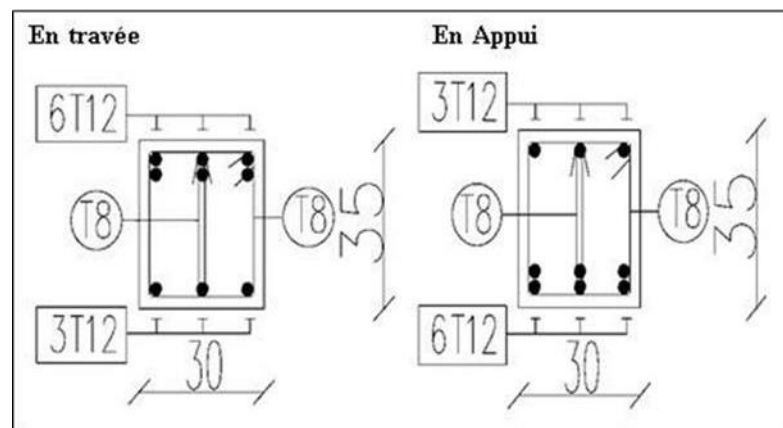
Schéma de ferrailage des poutres secondaires 30×35
